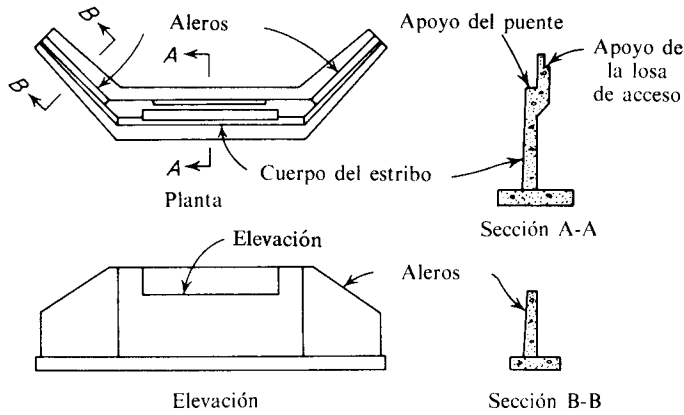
Estribo típico en voladizo para puente de carretera.
